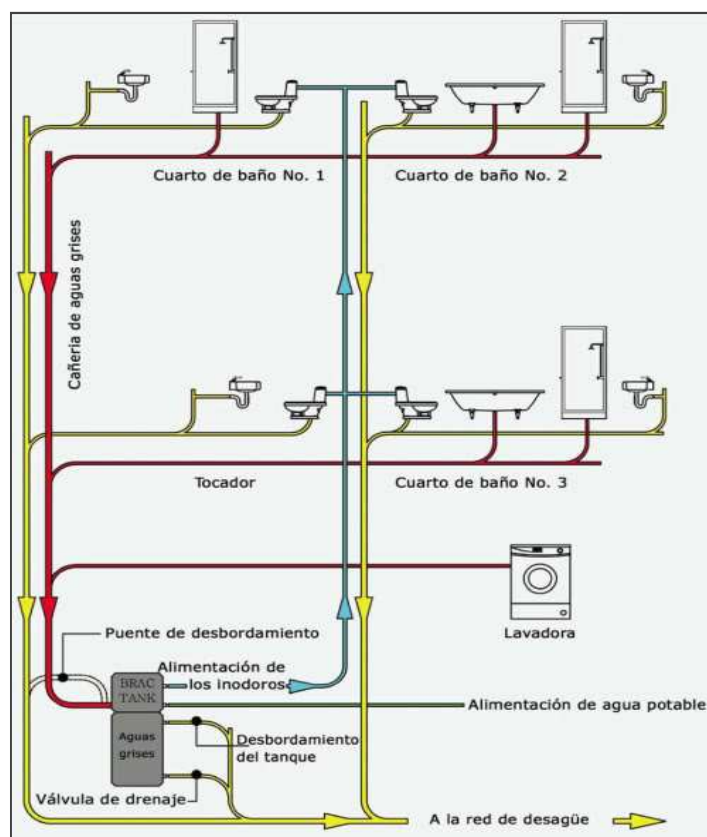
Ejemplo instalación de fontanería para Sistema Brac
